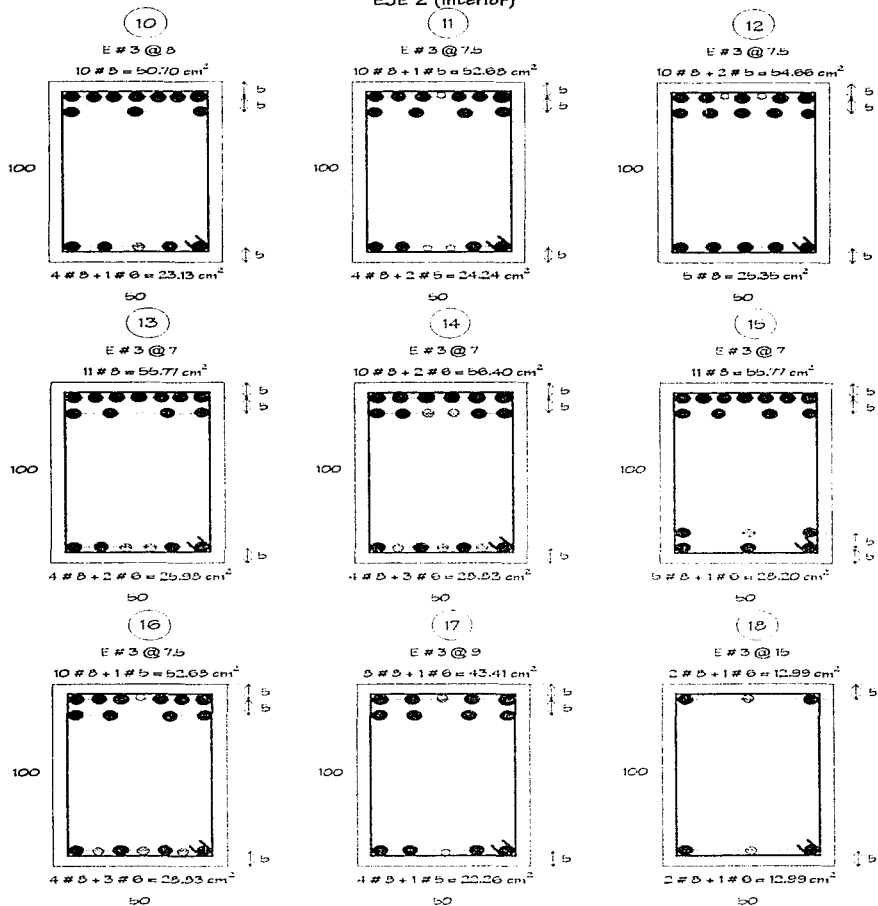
b).- Tipos de armados de las vigas del eje 2 del edificio de 17 niveles diseñado en la zona III
